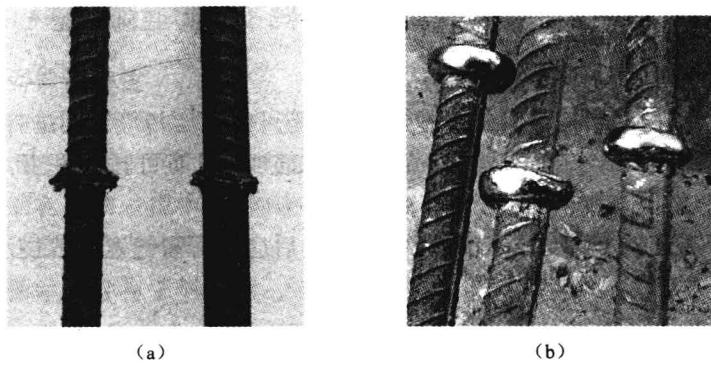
常见纵向受力钢筋焊接连接方式
